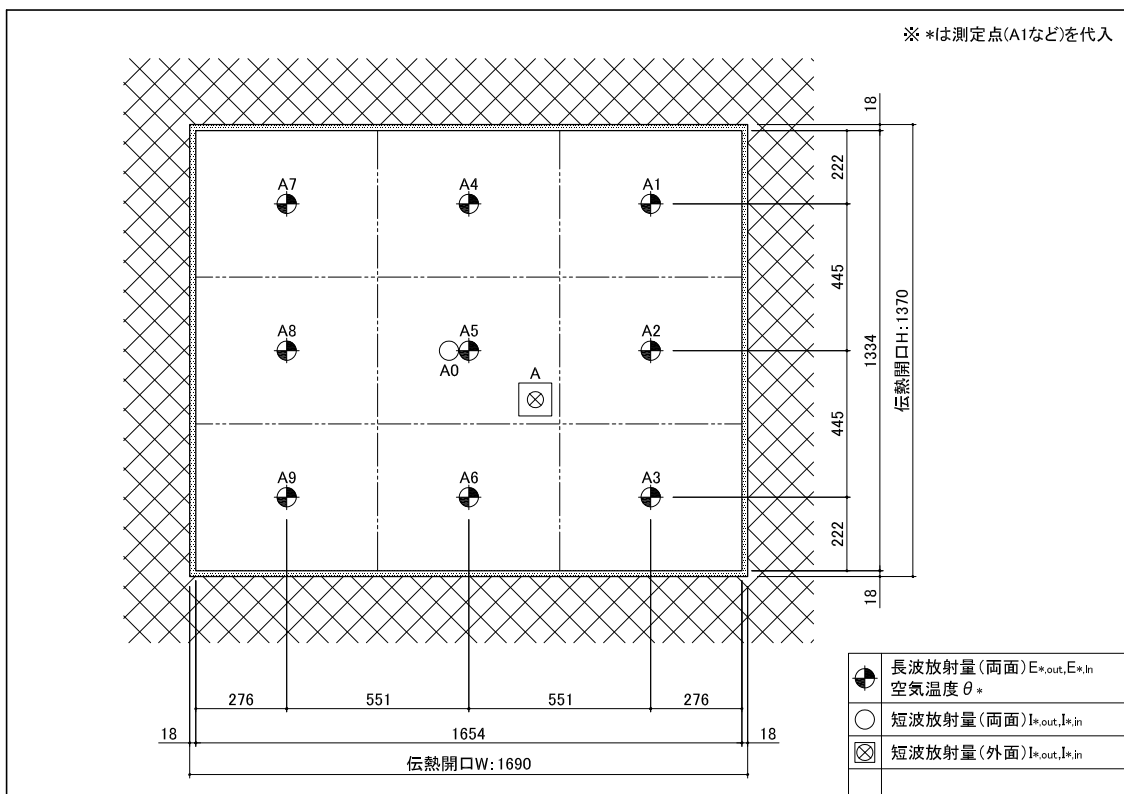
センサー配置図 (外気, Section A, ※内観を示す)
